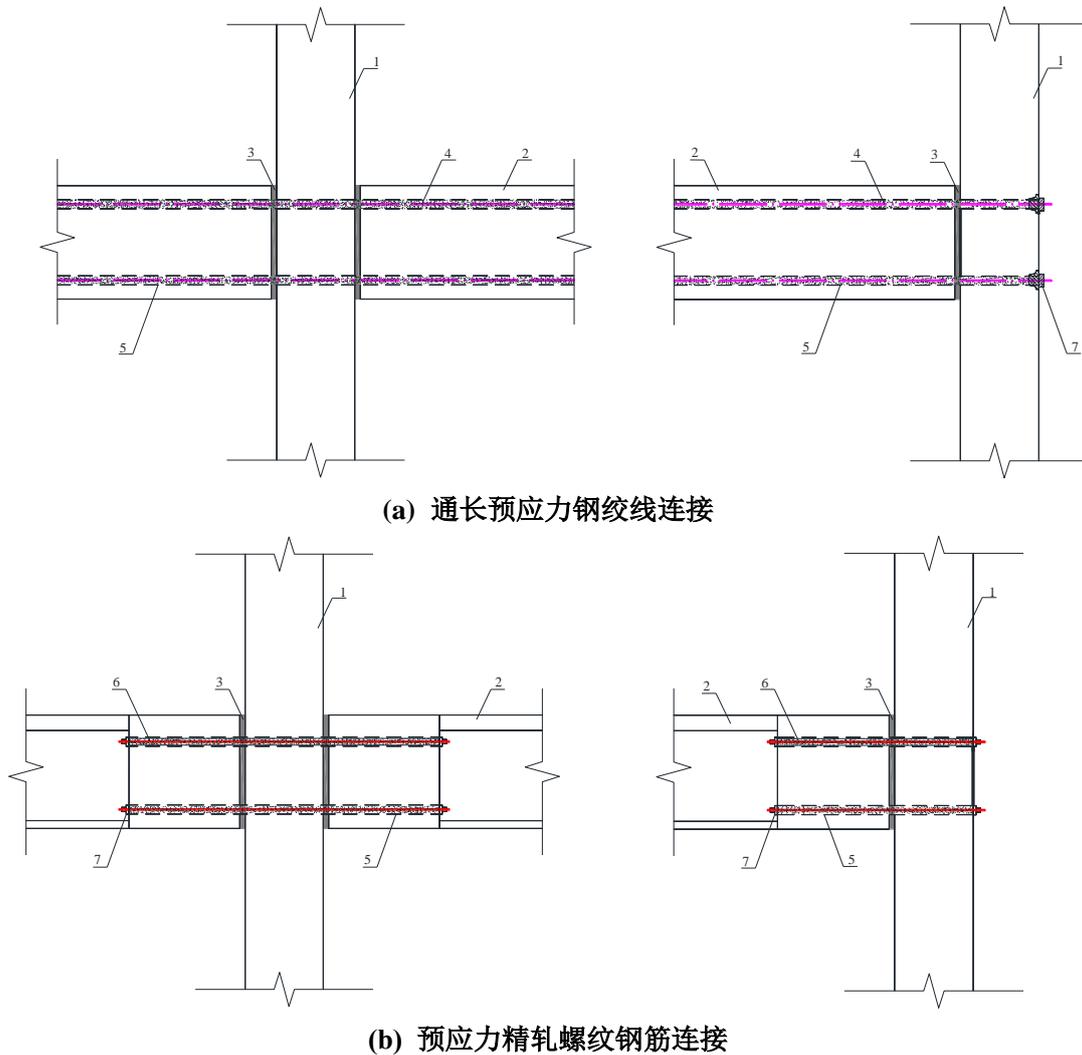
预制钢筋混凝土梁与预制柱的连接构造
